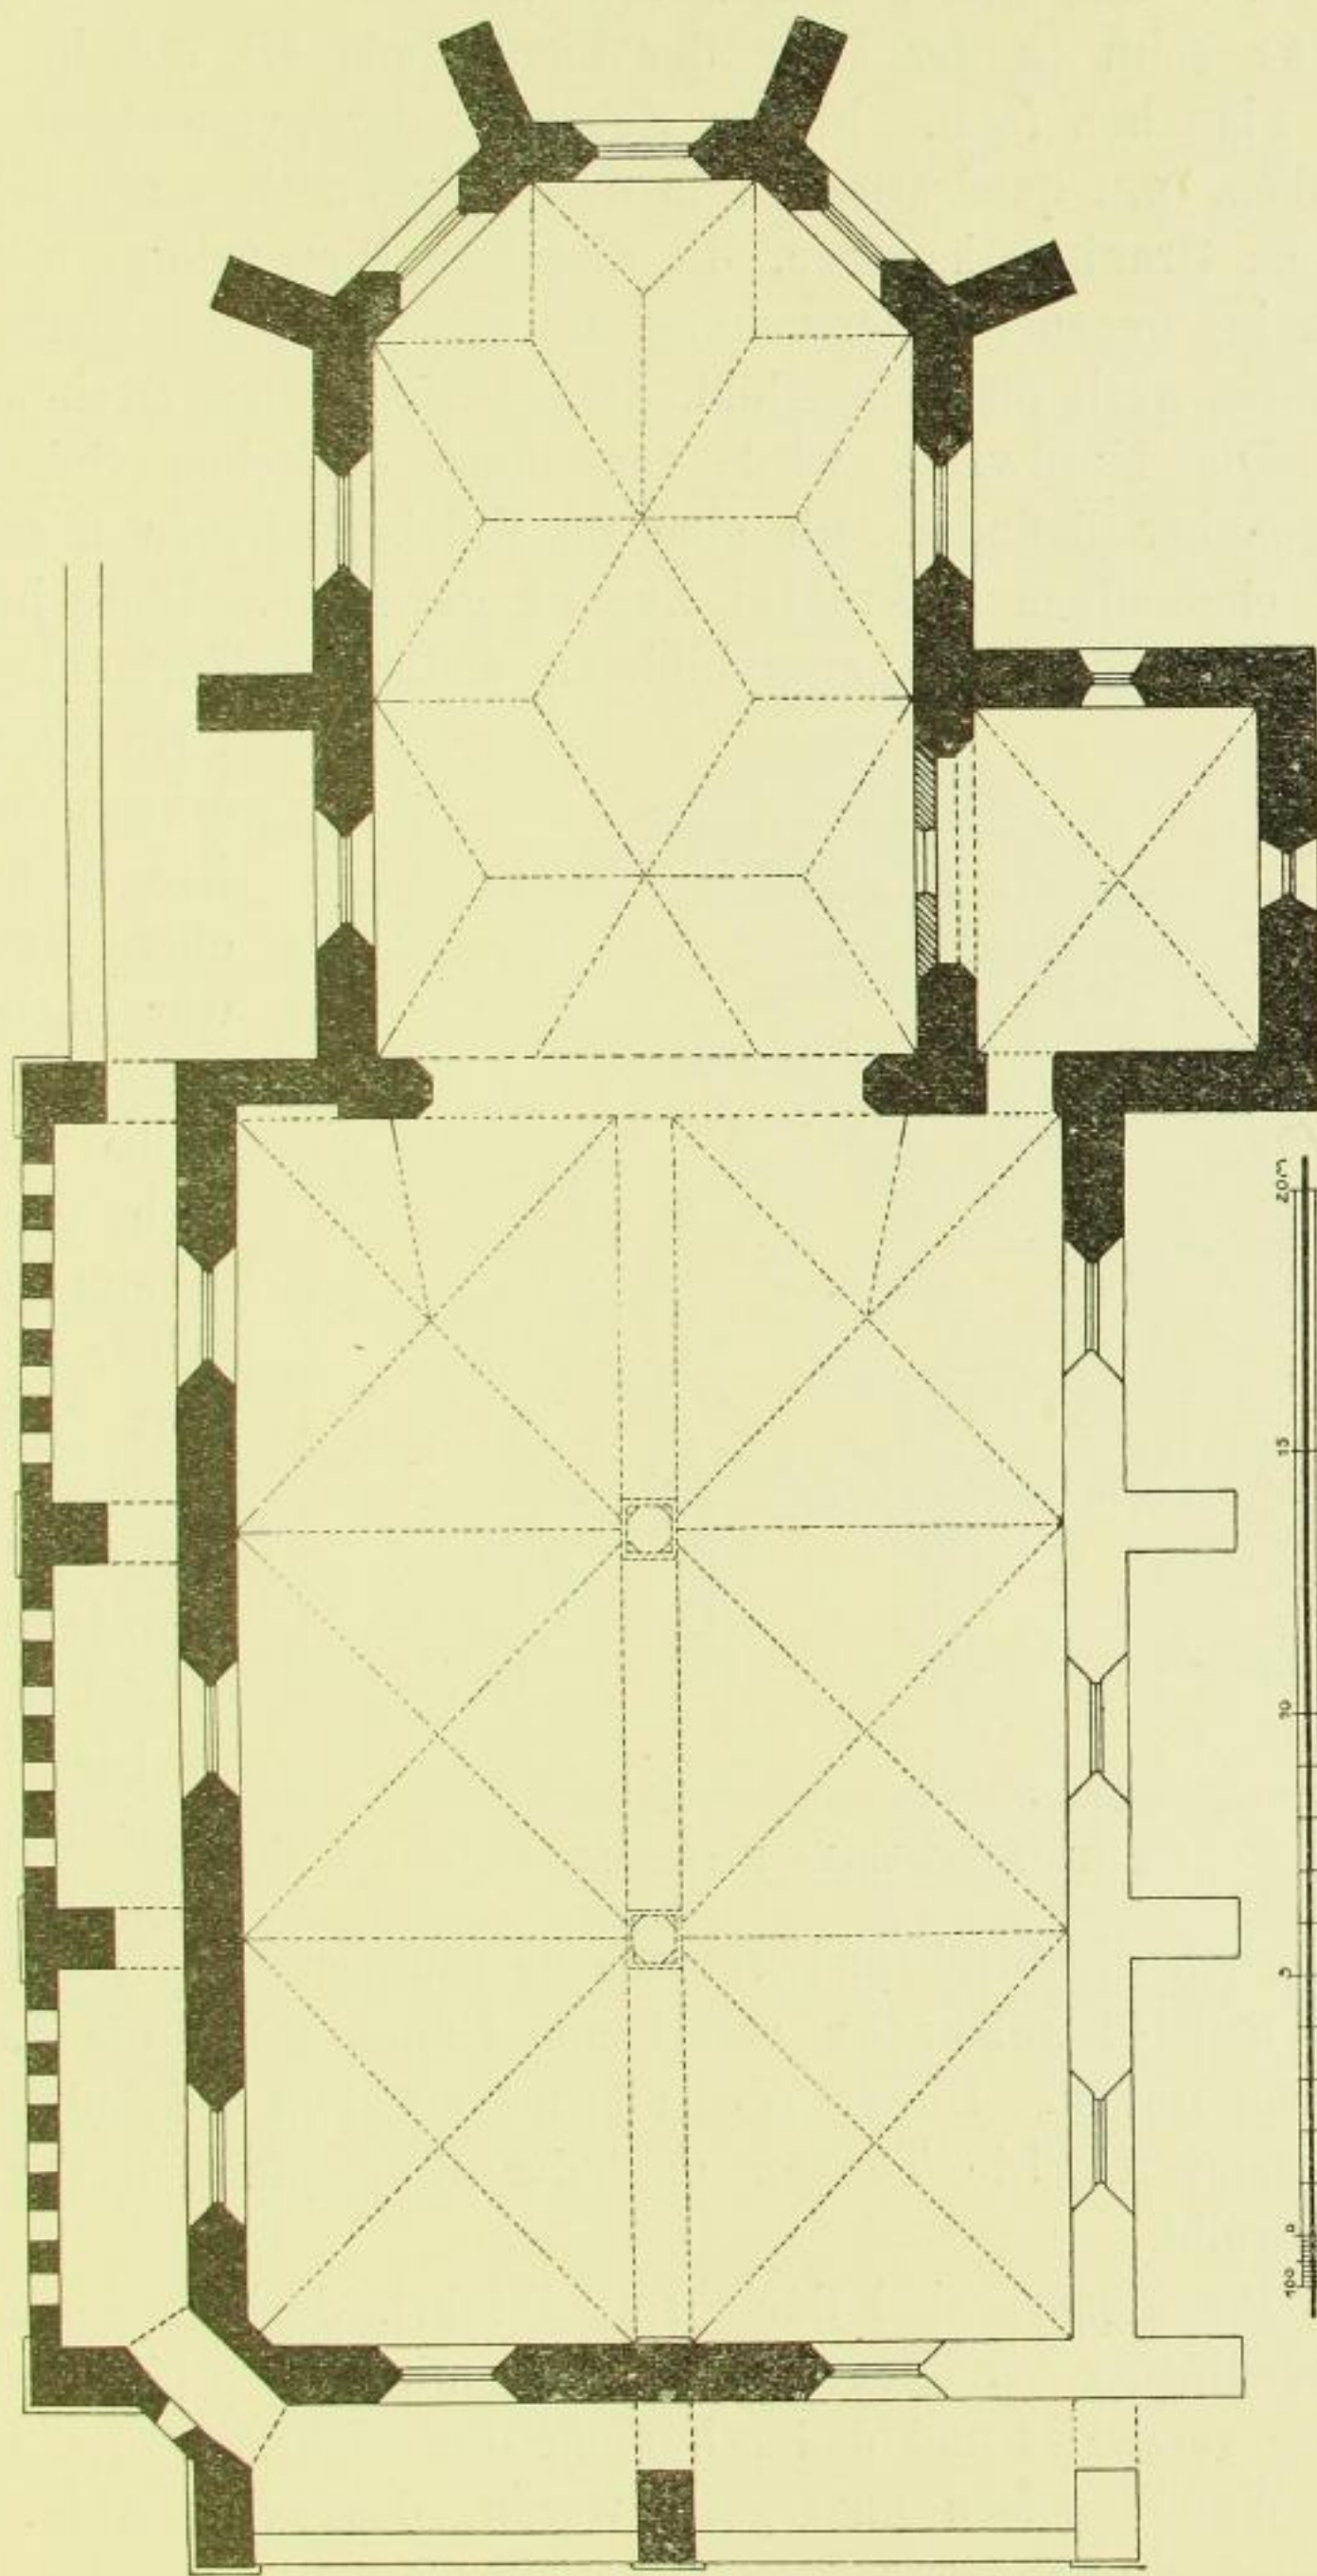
Nikolaikirche, Grundriß mit ergänztem Gewölbe.
